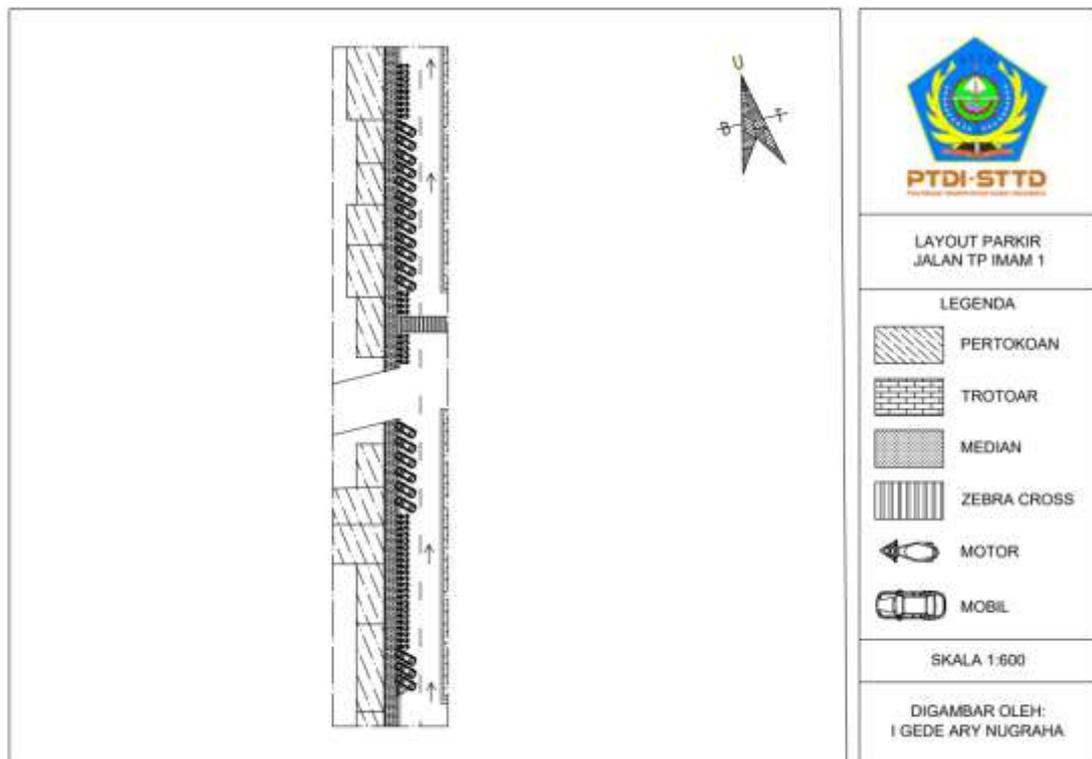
Layout Parkir On street Pasar Bobotsari
